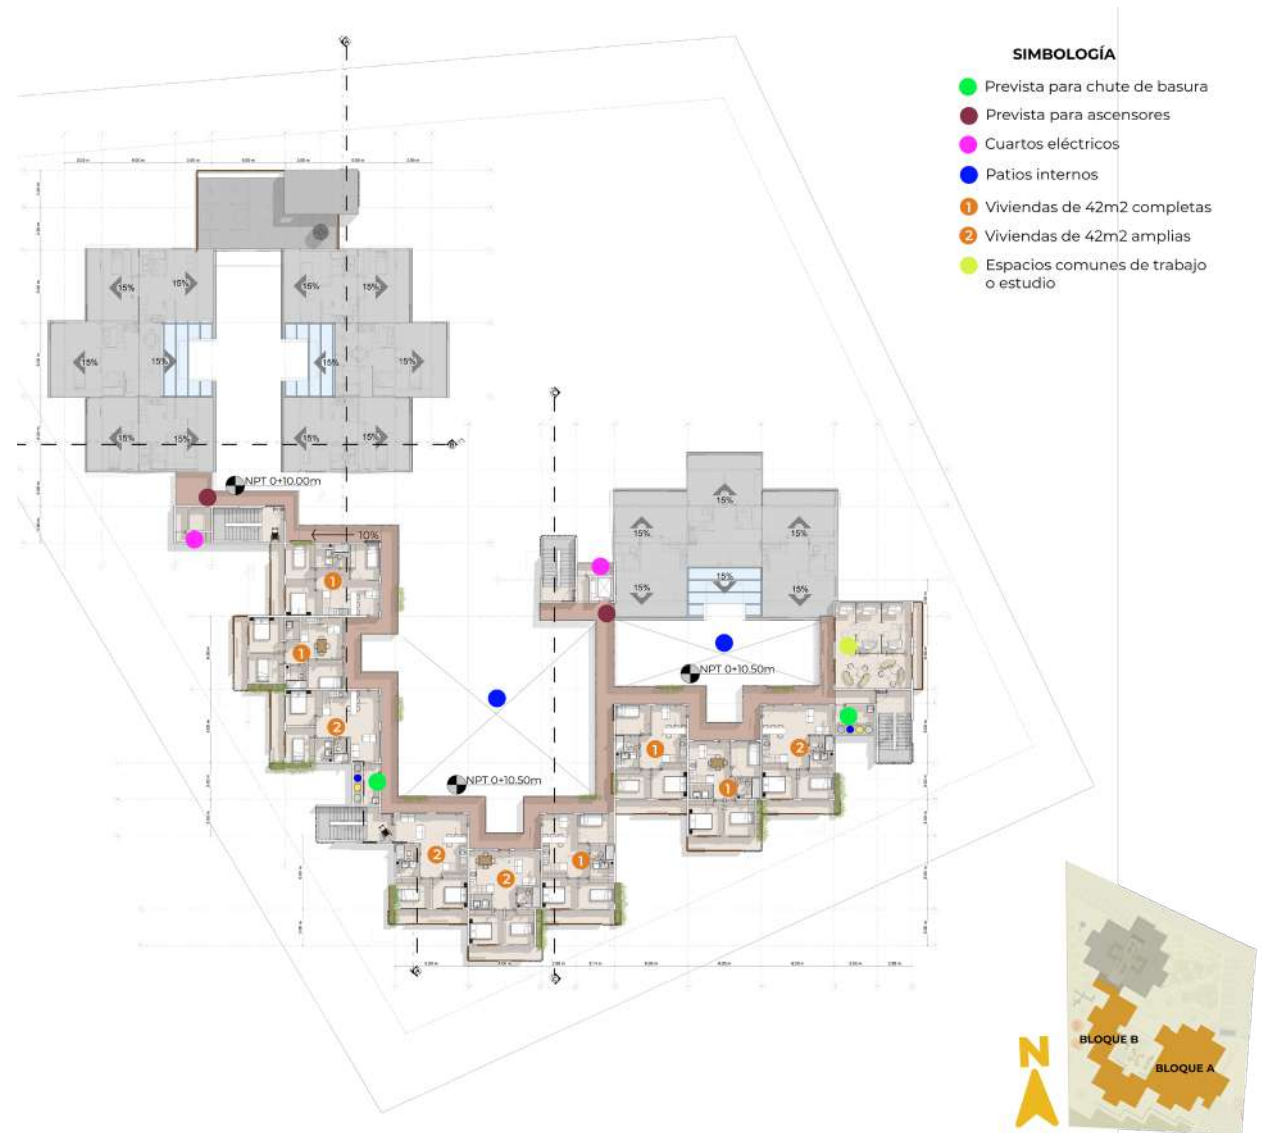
Planta de distribución arquitectónica nivel 4 - bloque A y B.
